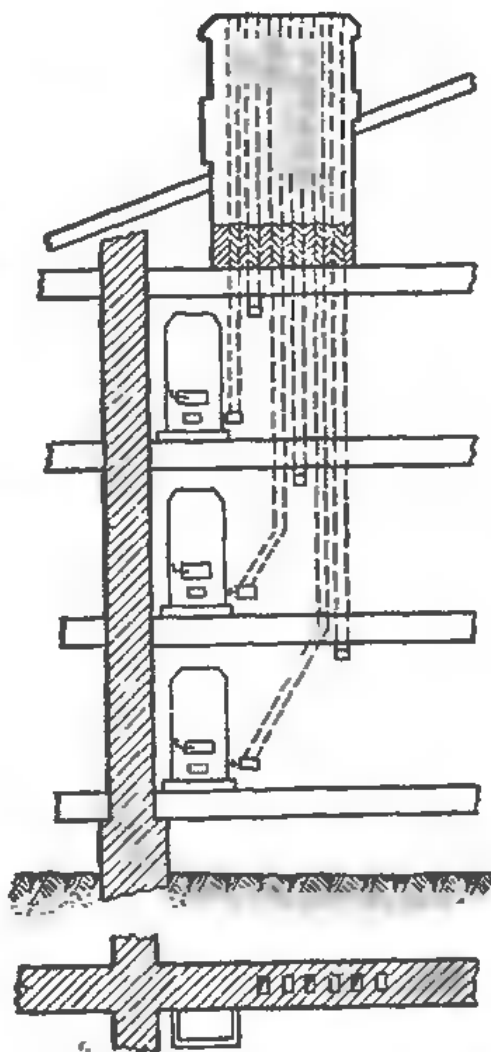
Размещение дымоходов в стене многоэтажного здания
